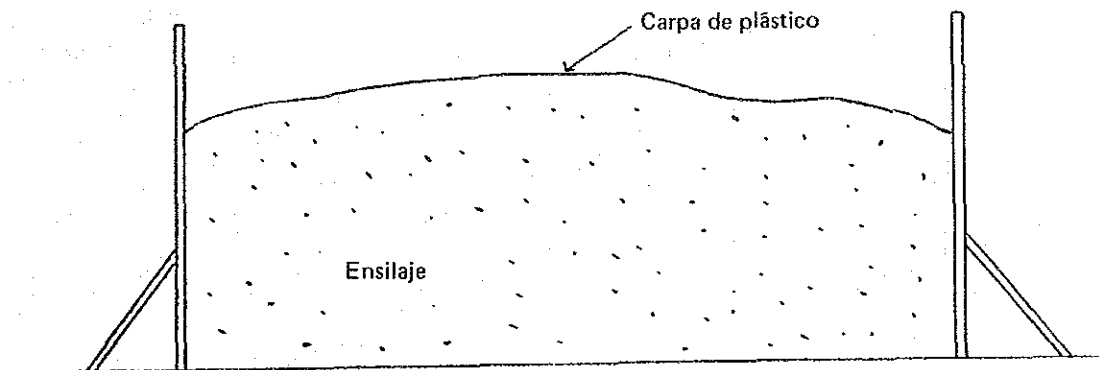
Plan de Sección del Silo Cajón 1/50
